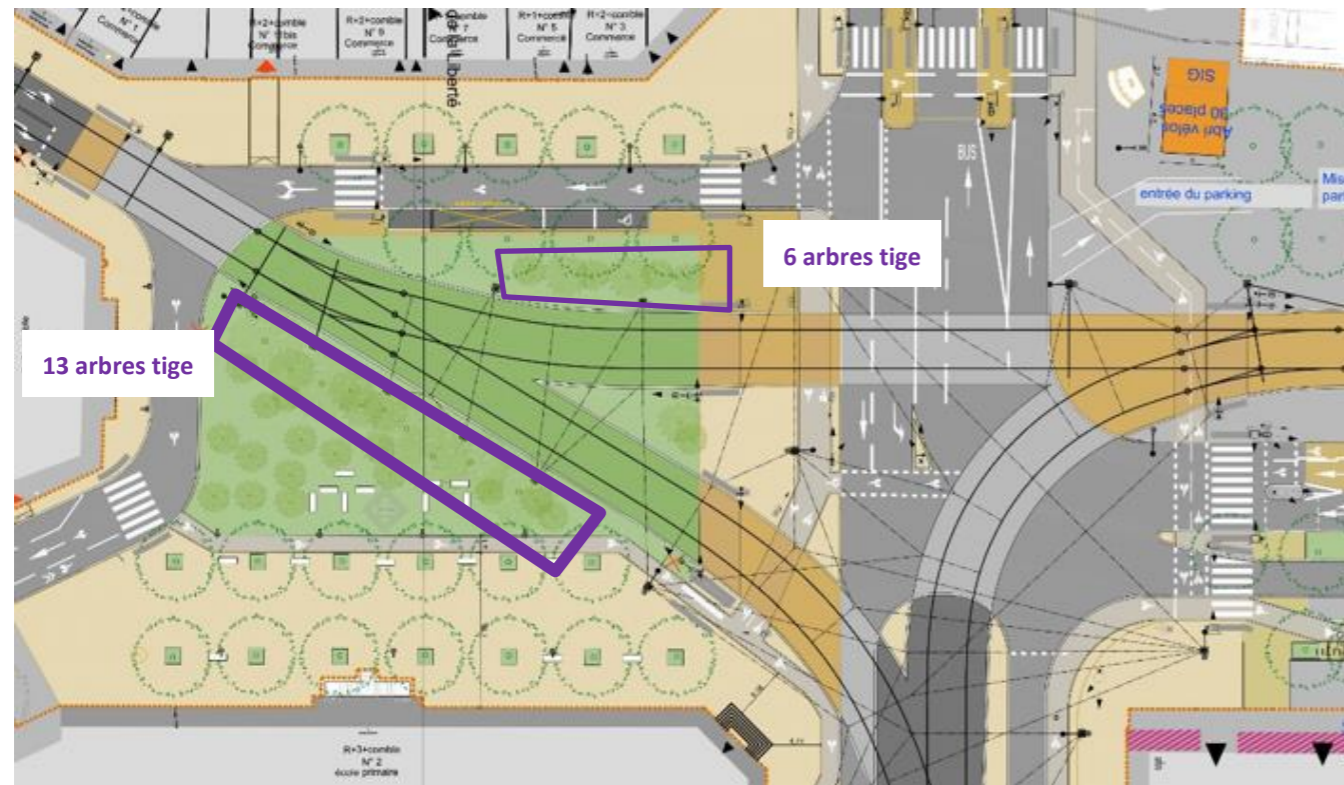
extrait plan de masse AVP2 – Place de la Liberté
